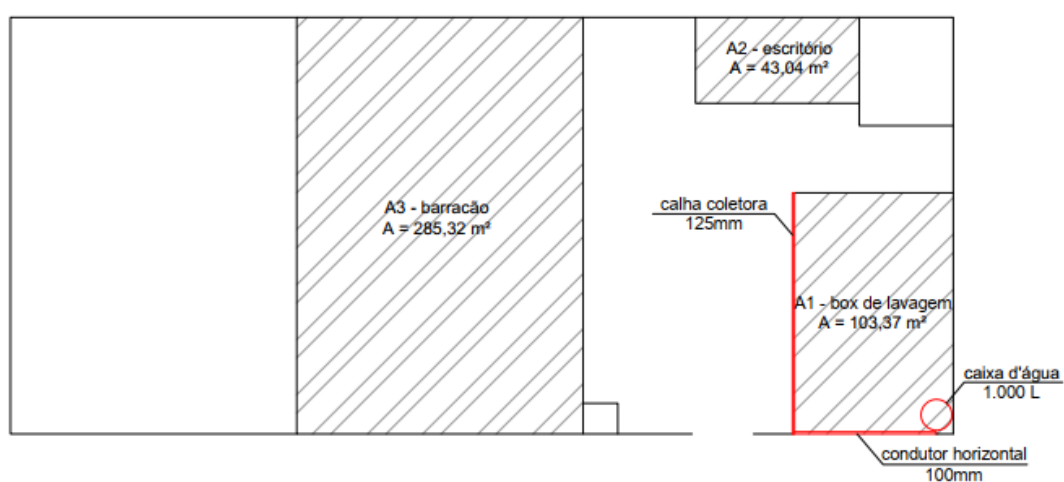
Planta das calhas coletoras e dos condutores horizontais do box de lavagem
